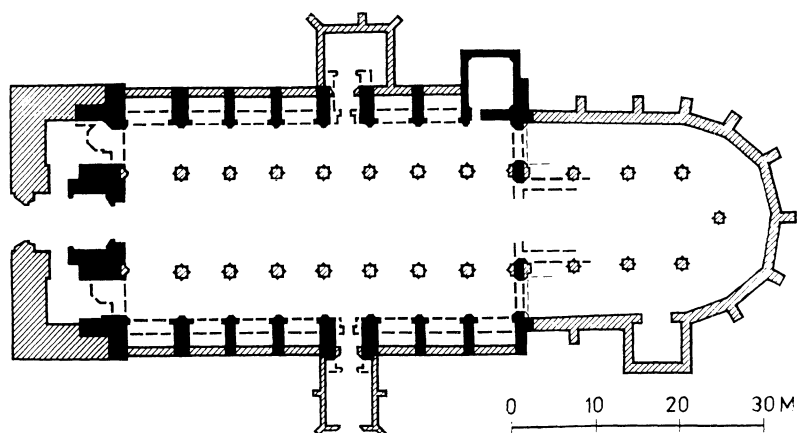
Dorpat (estn. Tartu): Grundriss der Domkirche
